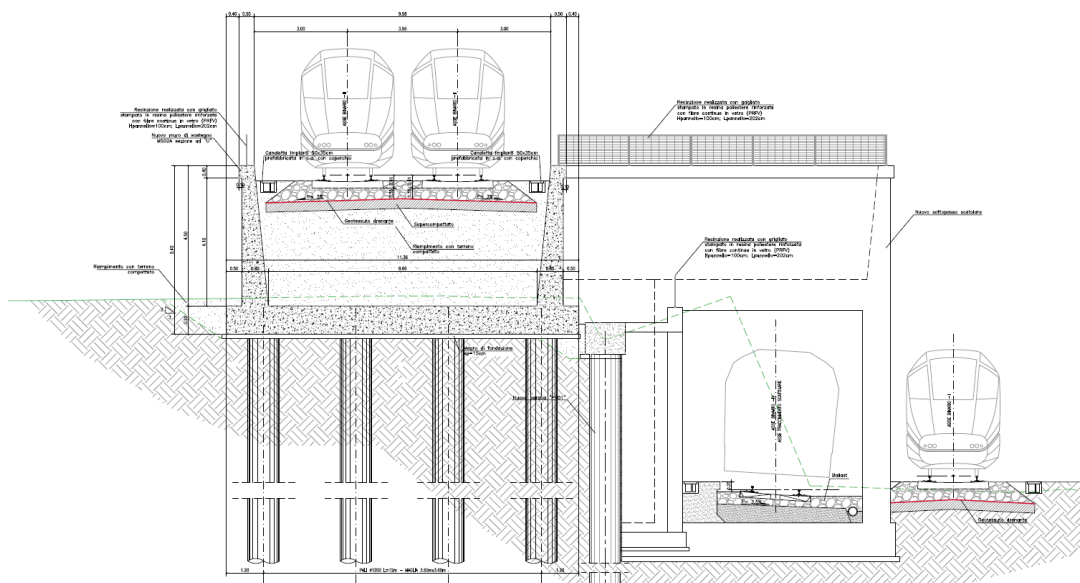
Sezione tratto a nord del nuovo ponte ferroviario sulla linea RFI in affiancamento al sottopasso del “passantino” in progetto (sezione muro MS02)
